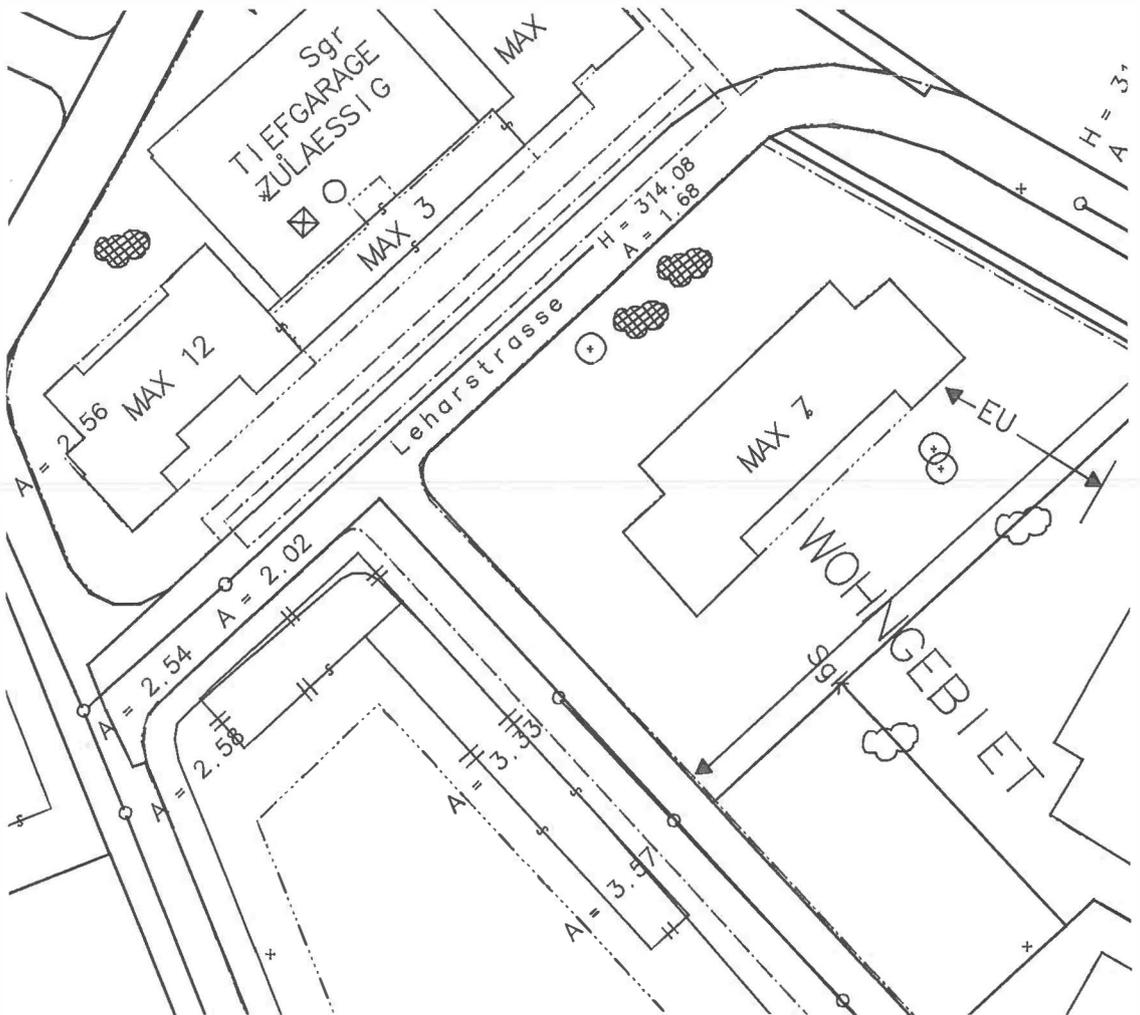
Bebauungsplan - Ausschnitt im M 1:1000
